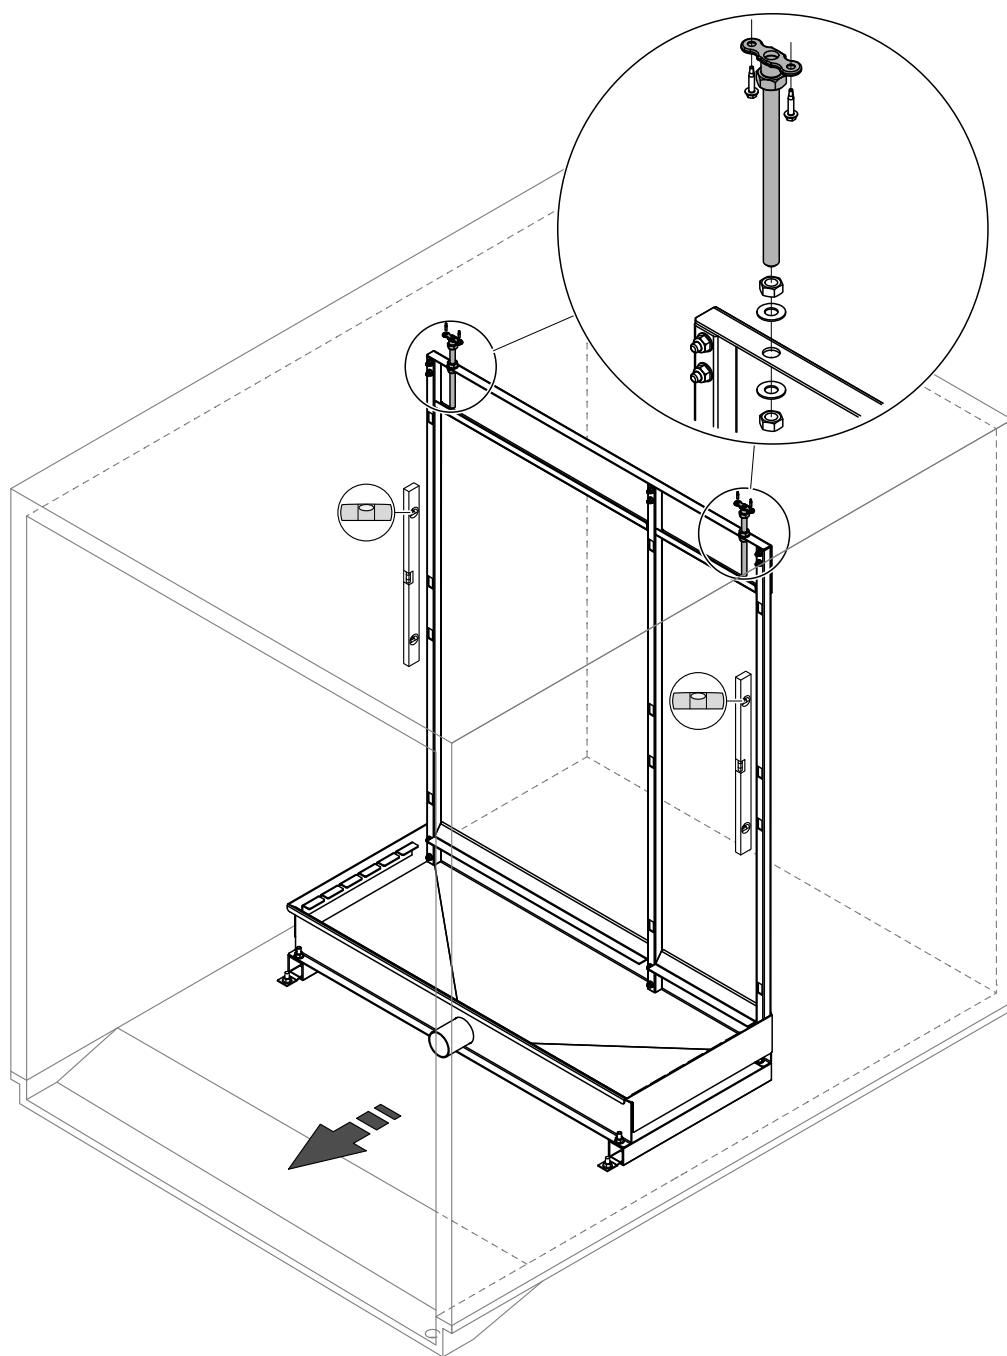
Fissare l'elemento trasversale al soffitto dell'UTA/del condotto
